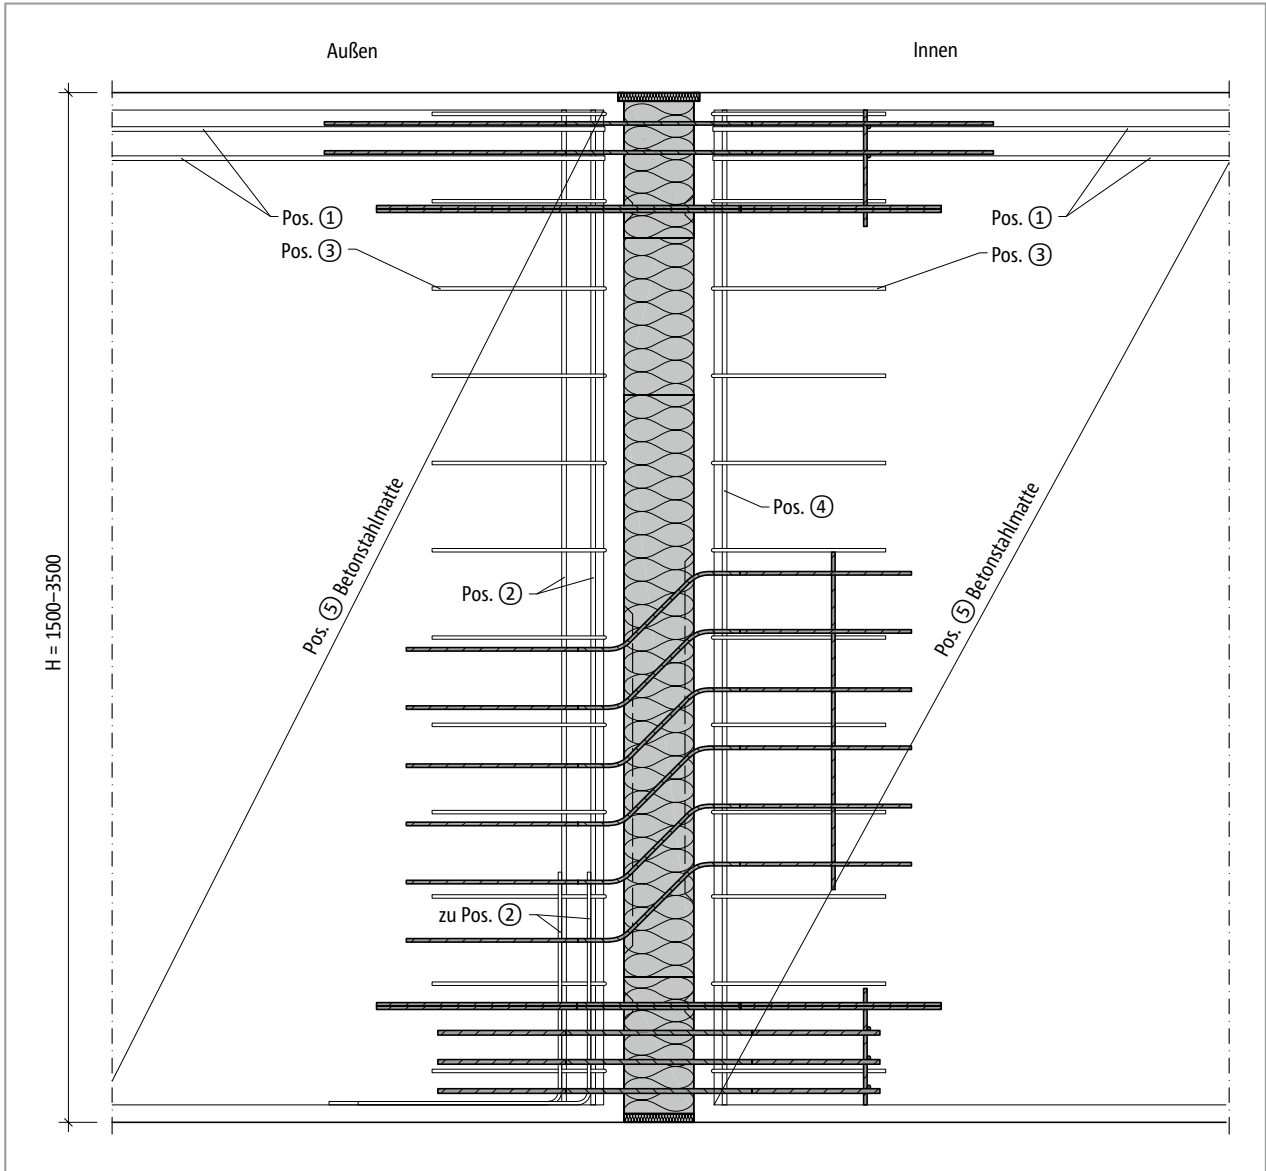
Schöck Isokorb® XT Typ W: Bauseitige Bewehrung; Schnitt
